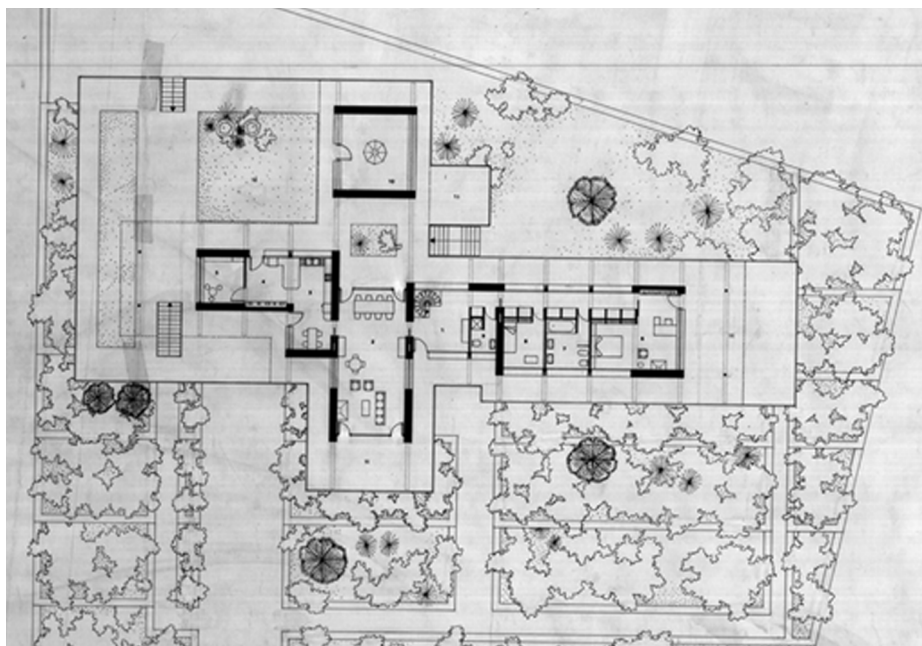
Plano Planta principal de la Casa Santonja, plano original de Higuera.
